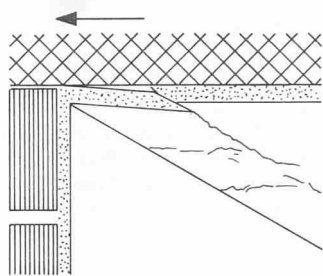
Rissbildung im Deckenputz unter der obersten Geschossdecke, bedingt durch Dehnung der Betonkonstruktion und durch das Fehlen des Schwedenschnittes
